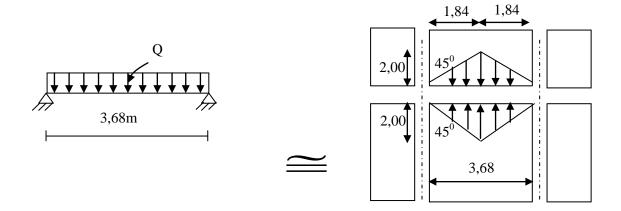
Répartition des charges sur les poutres selon Les lignes de rupture.
